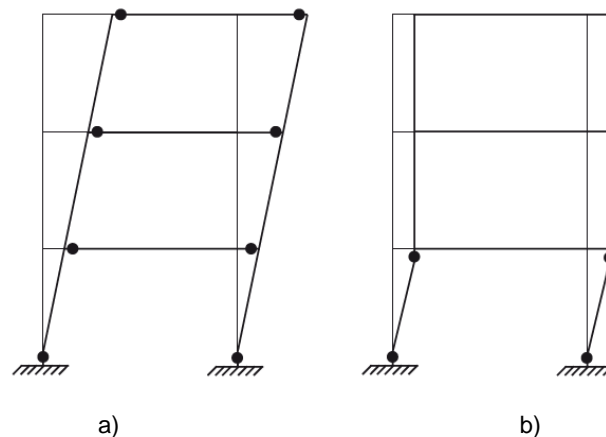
Zonas de formação de rótulas plásticas, a) Mecanismo pilar forte / viga fraca; b) Mecanismo pilar fraco / viga forte.
